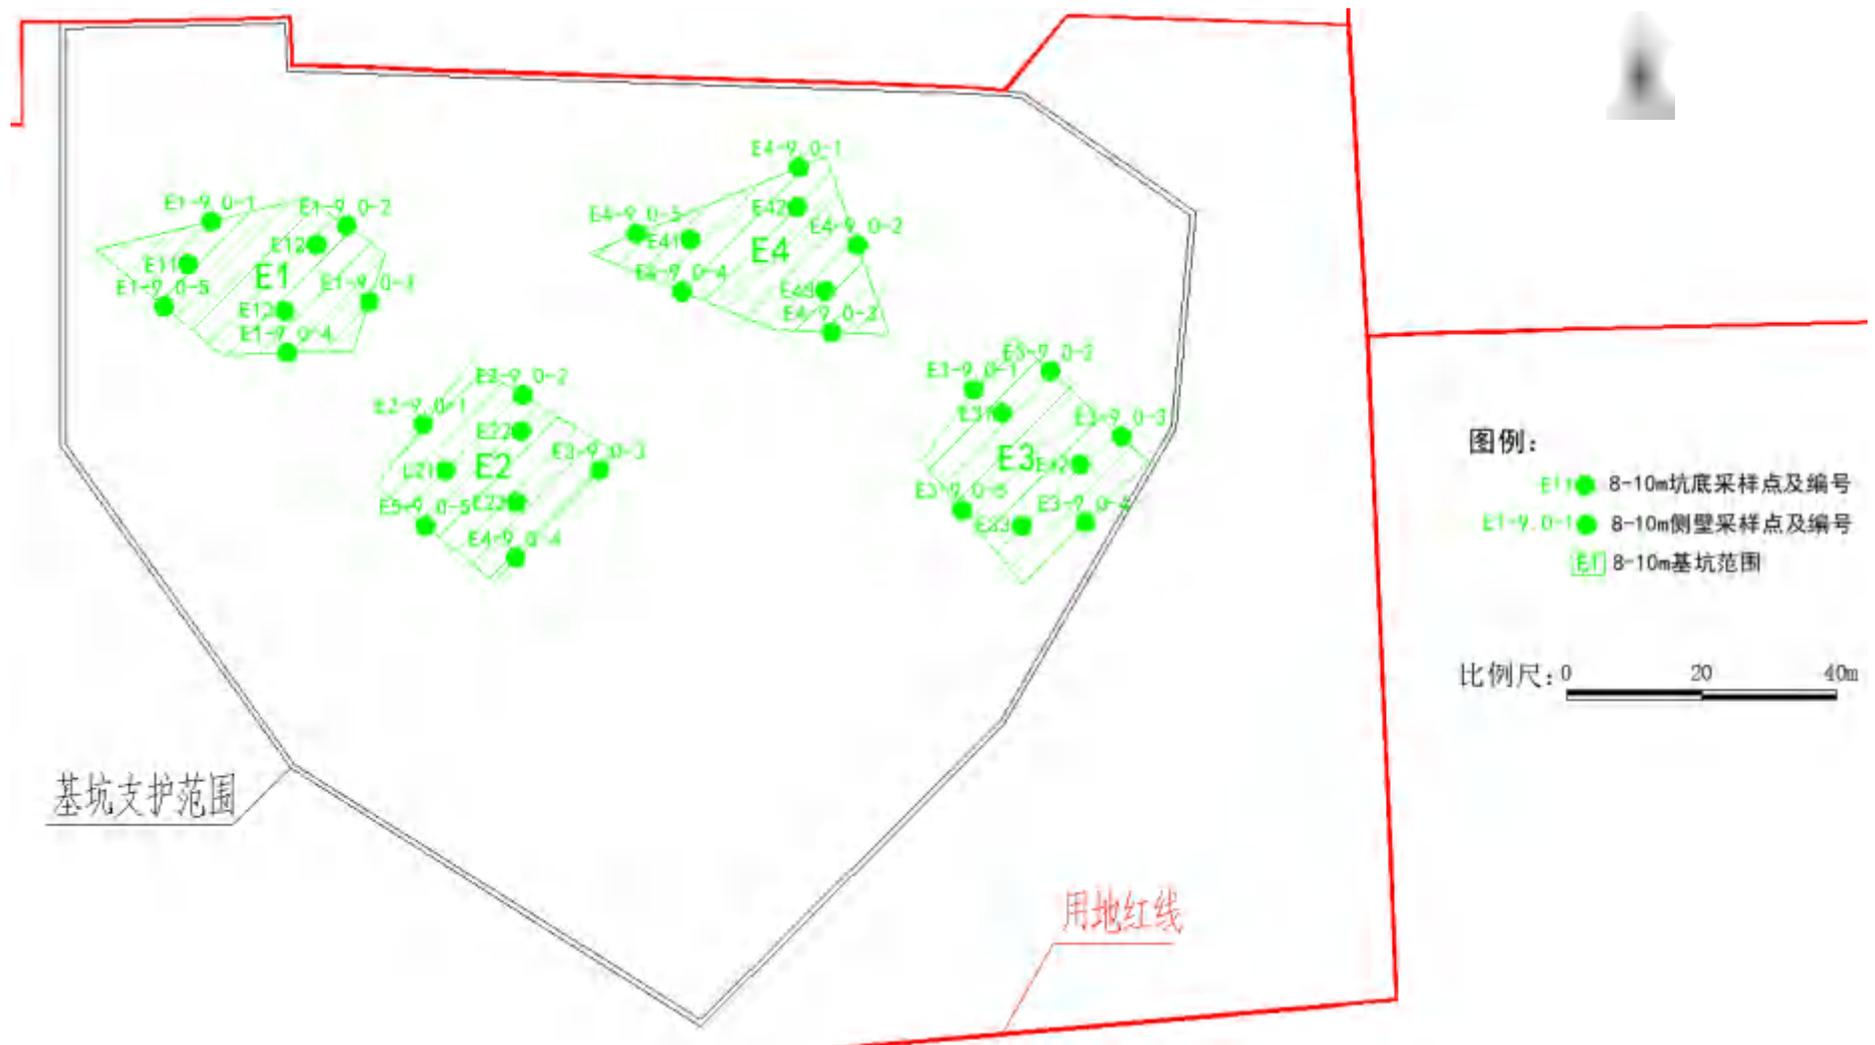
基坑侧壁和底部采样点平面布置图（8-10m）
